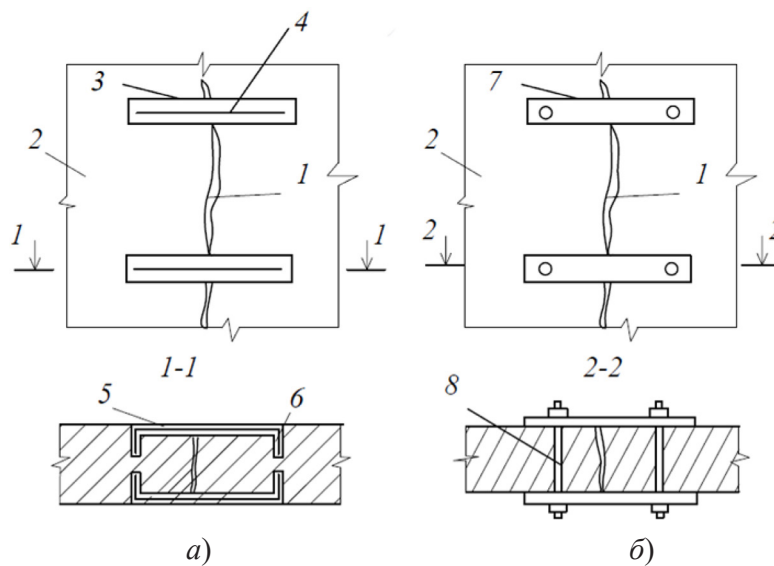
Усиление кладки в каменных стенах в зоне трещин скобами и накладками: а – установка шпенок-скоб из арматурных стержней; б – установка стяжных болтов с накладками; 1 – трещина; 2 – усиливаемая стена; 3 – штраба, заполненная бетоном; 4 – скоба из арматуры; 5 – паз, выбранный фрезой; 6 – просверленные углубления; 7 – стальная накладка; 8 – стяжной болт
